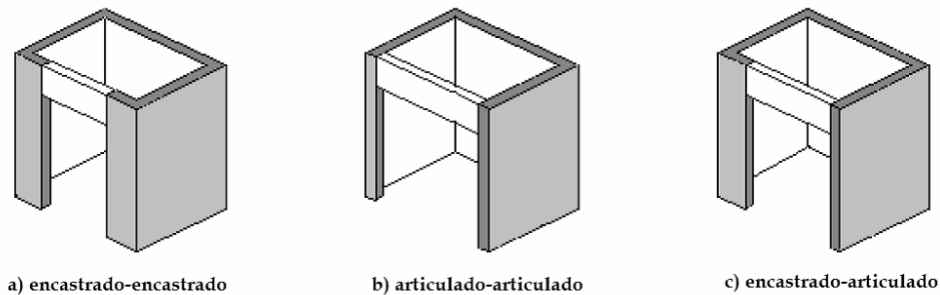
Ligação Viga - Parede Resistente [7].
